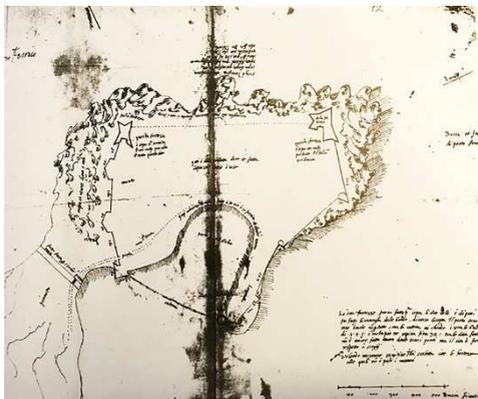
Rilievo planimetrico della città-fortezza di Portoferraio redatto da Giovanni Bellucci nel 1552 (Biblioteca Apostolica Vaticana, Barberiniano Latino).
